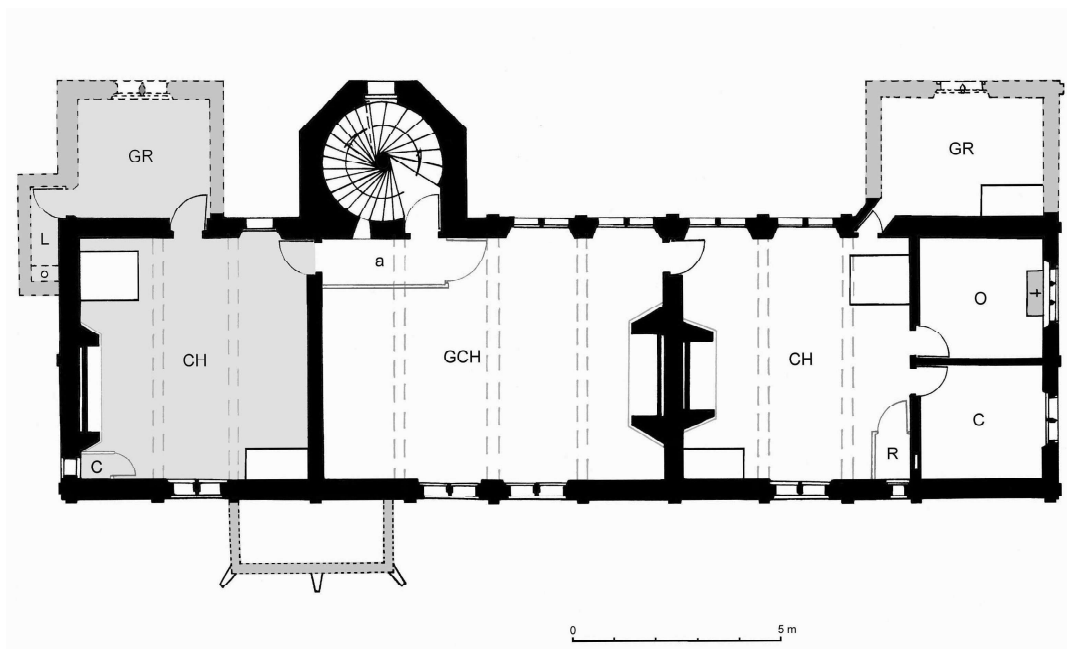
Sénitot. Plan restitué du premier étage entre 1528 et 1536 (en gris clair : logis du roi).
